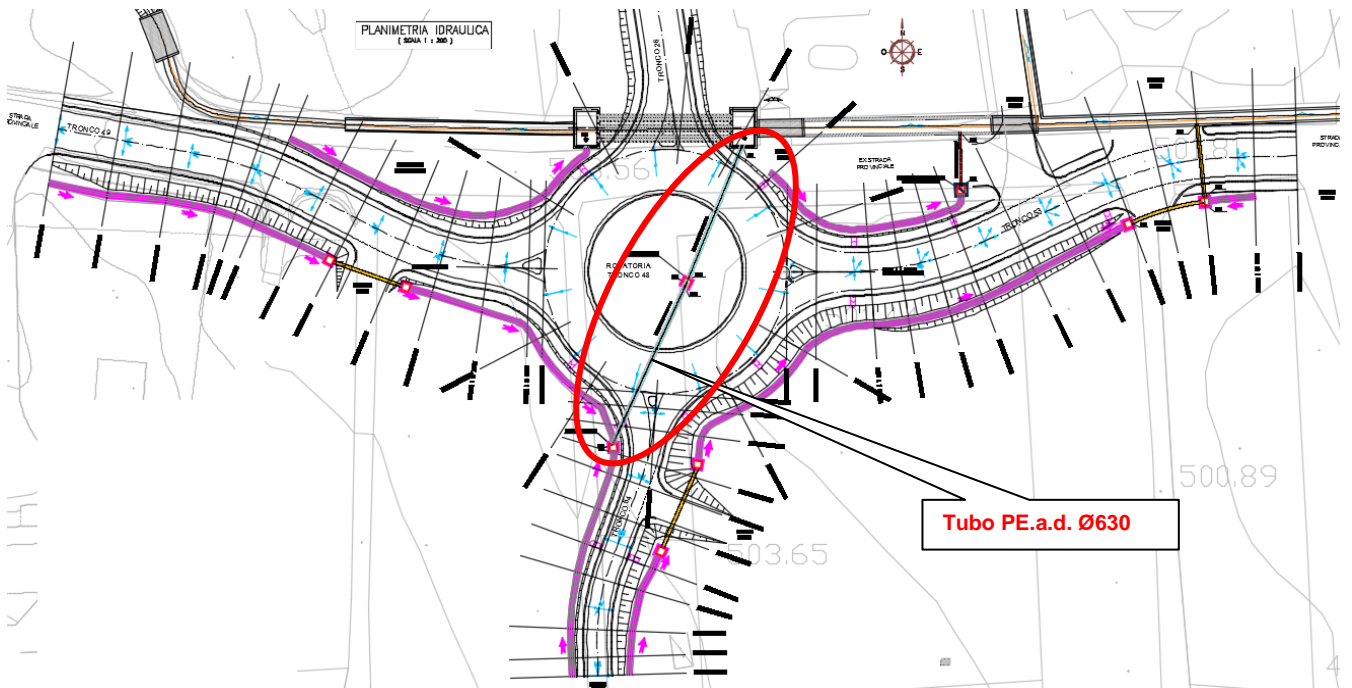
Stralcio planimetrico da Progetto di Dettaglio
